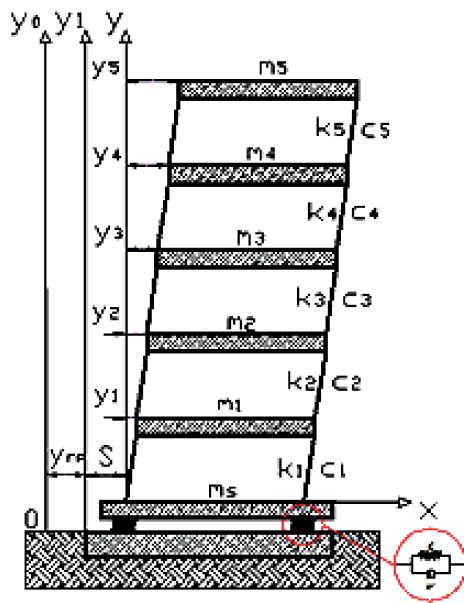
Расчетная схема здания с сейсмоизоляцией в плоскости
